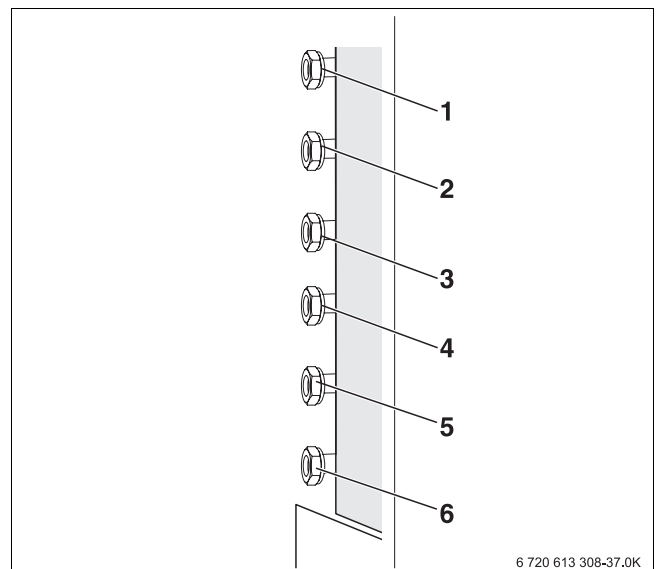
Collegamenti con set di collegamento laterale (accessorio)
